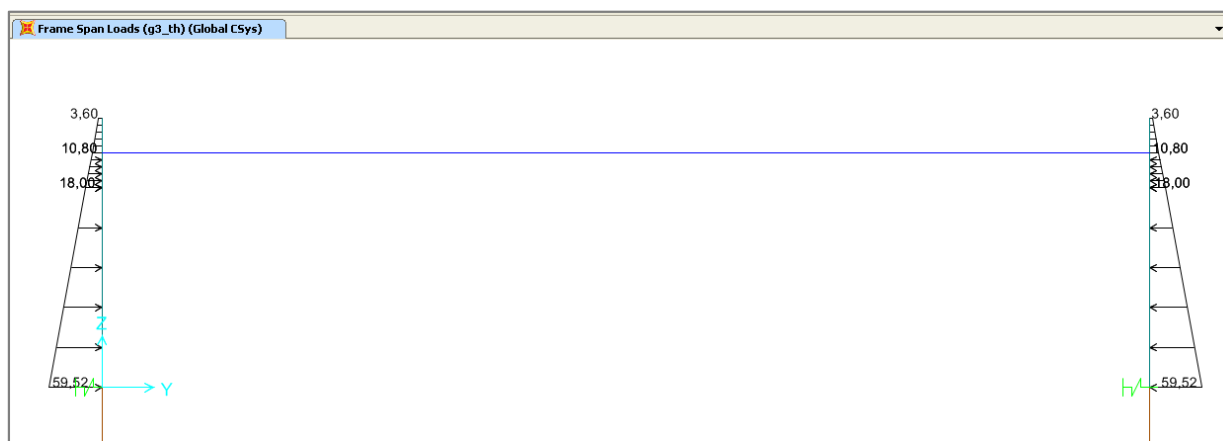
Spinta delle terre sulle spalle.
